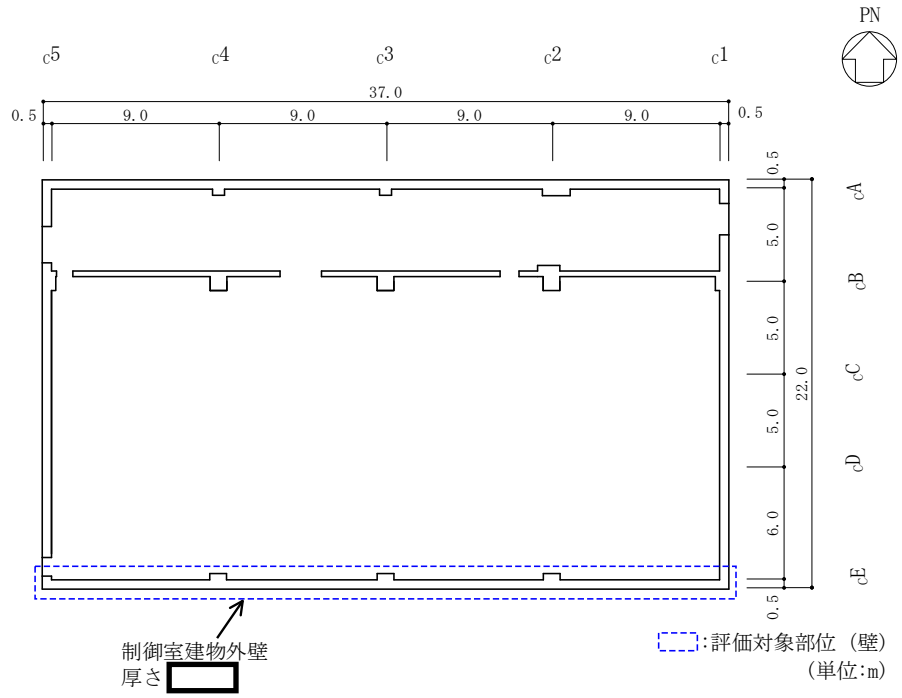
(1) 制御室建物の概略平面図 (EL 16.9m)
